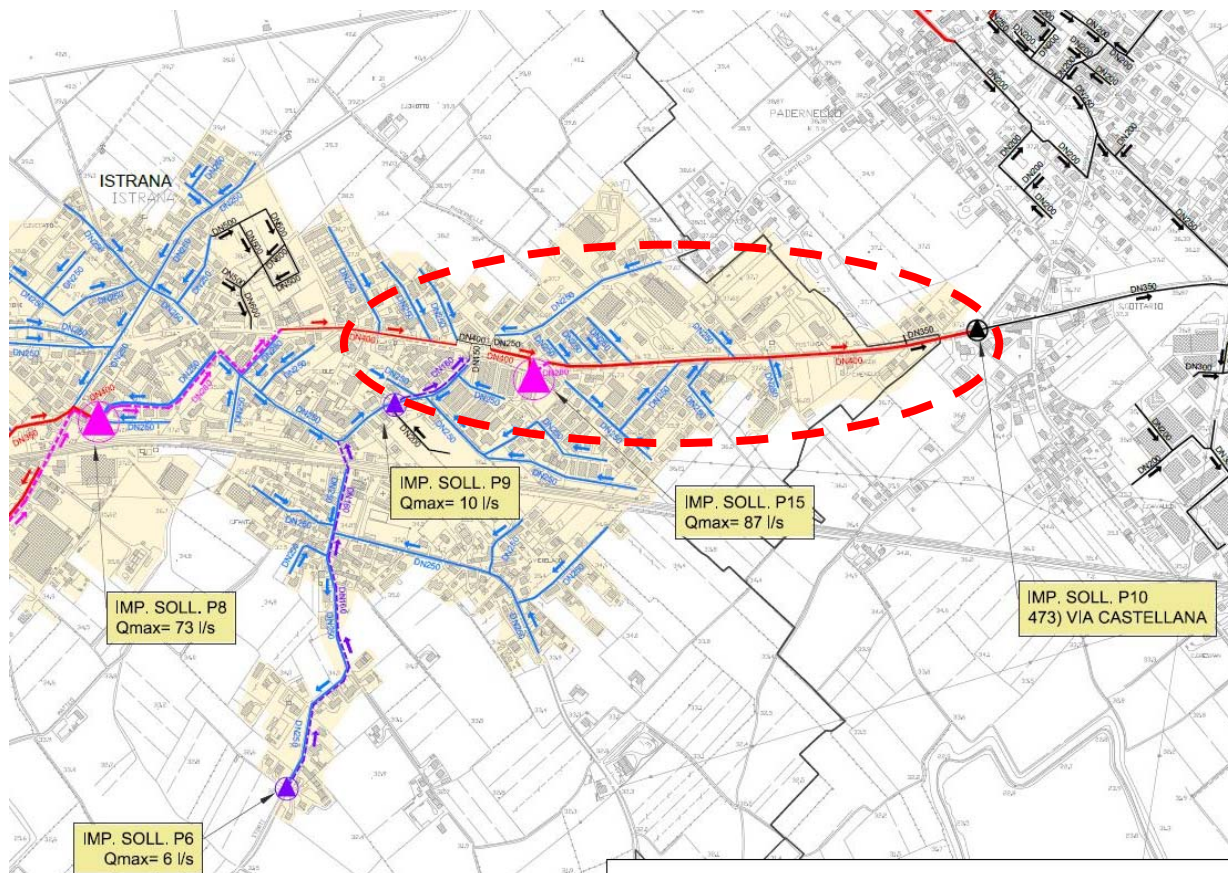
Planimetria della rete di progetto – Stralcio comune di Istrana
